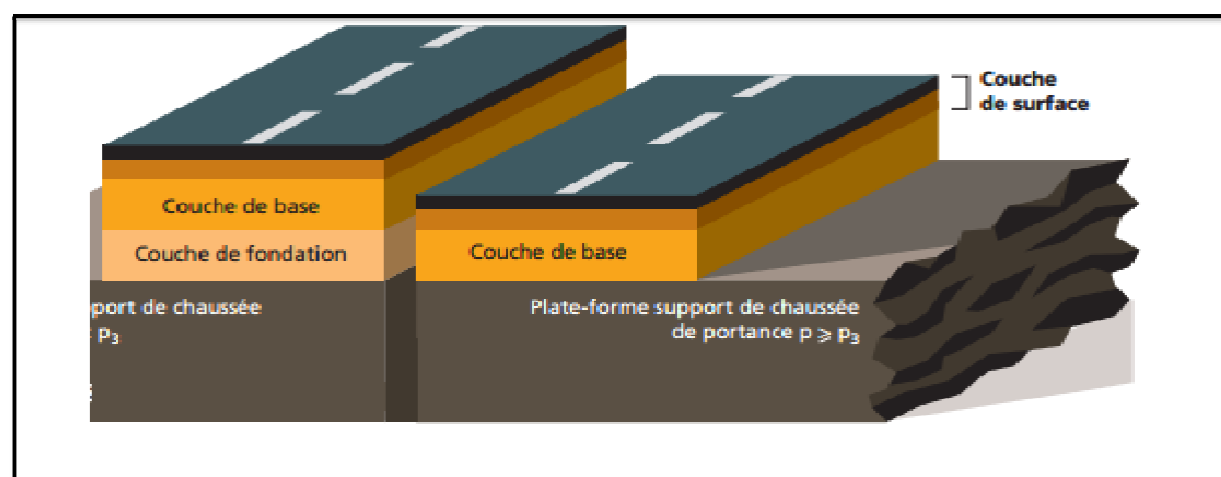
Structure type d'une chaussée semi-souple. [17]
